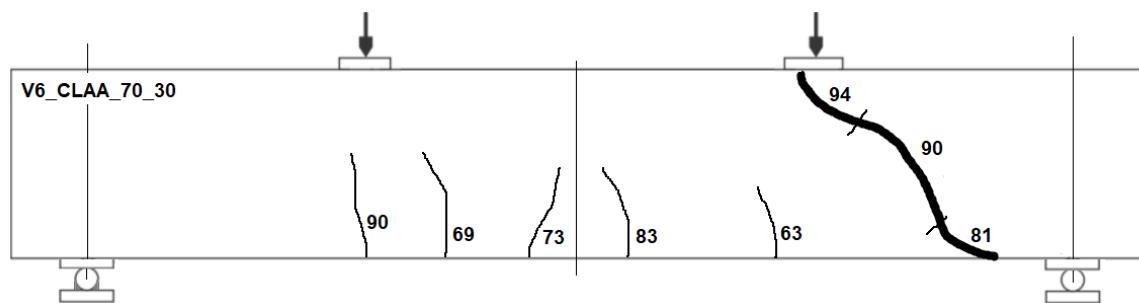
Esquema de fissuração da Viga 6_CLAA_70_30.
